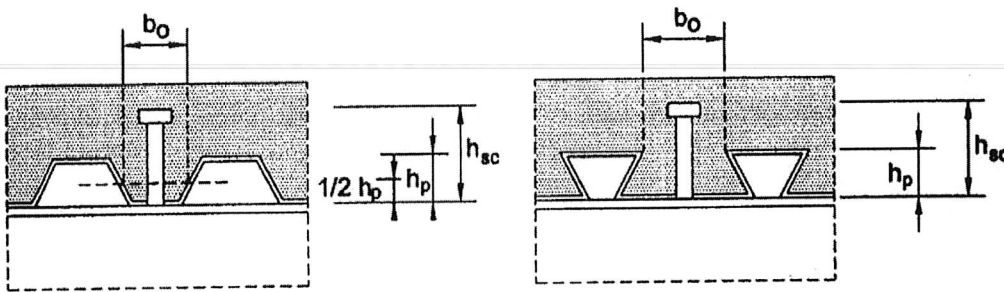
Profilbleche mit Rippen senkrecht zum Träger [1.11, Bild 6.13]
